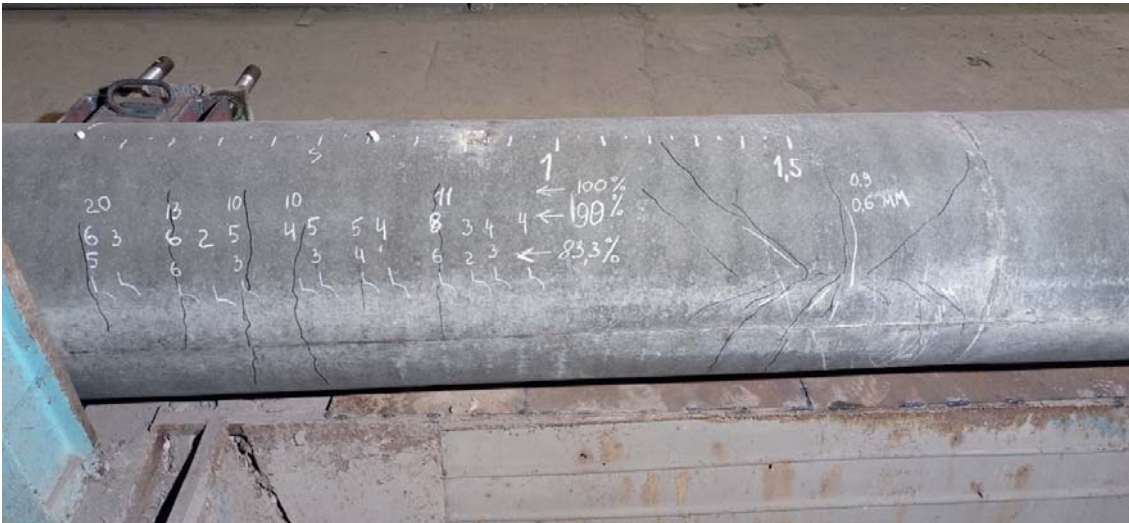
Фрагмент стойки СКЗ у заделки. Схема раскрытия трещин
